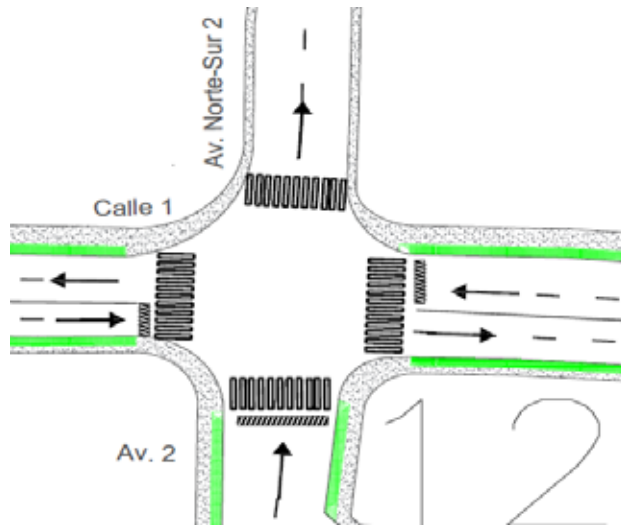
Intersección 12-Avenida Norte-Sur 2-Avenida 2-Calle 1
